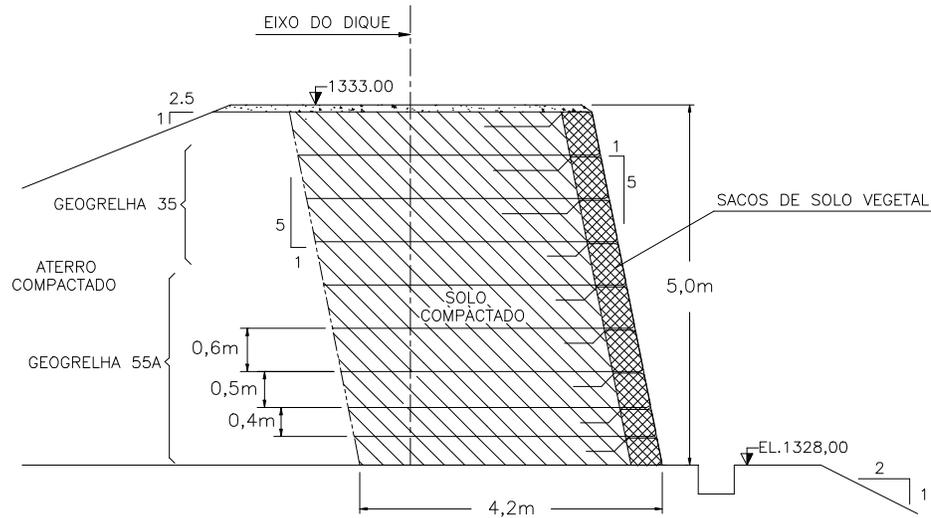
Detalhe da seção transversal típica do muro de solo reforçado.
